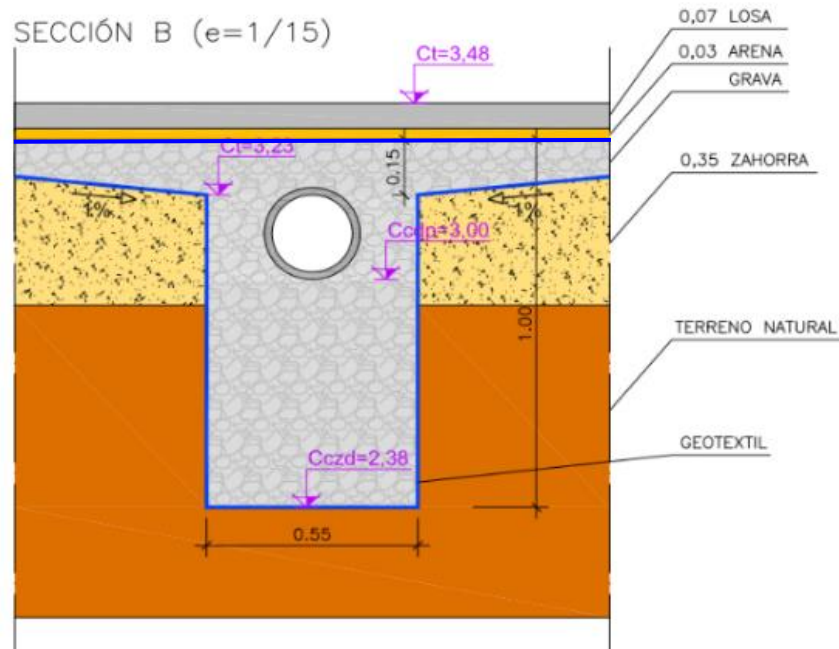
Sección bajo pavimento permeable en la plaza Lorenzo de la Flor.
